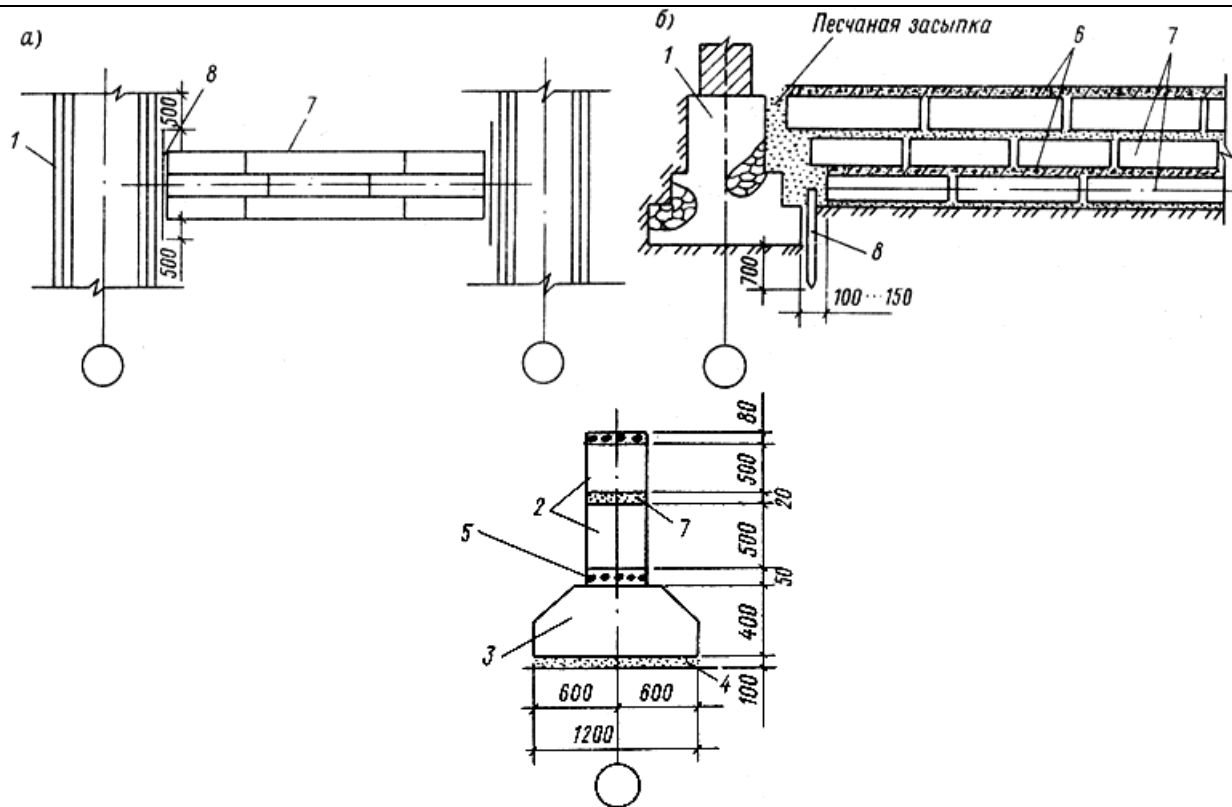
Схема сборного ленточного фундамента под новую внутреннюю стену здания
